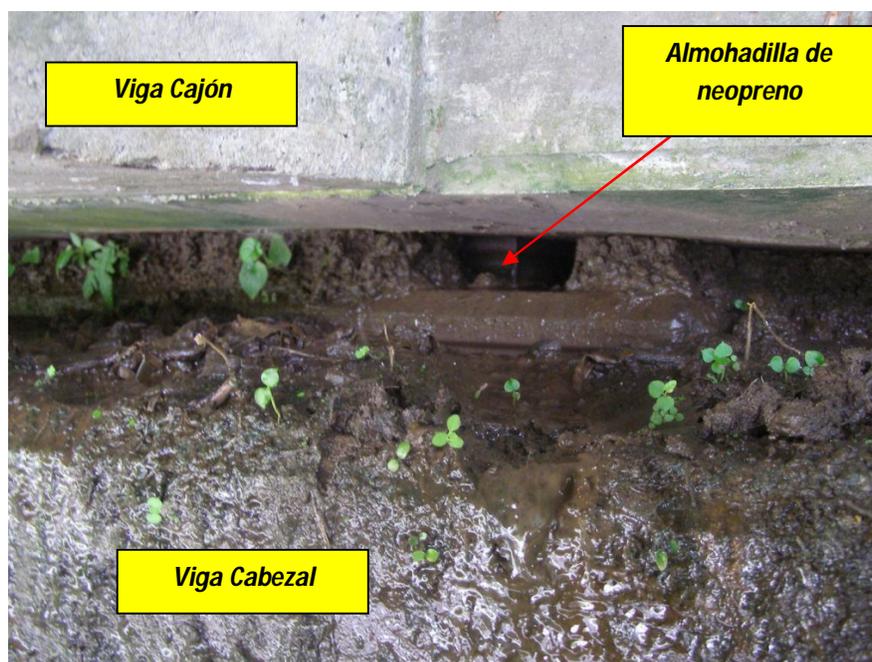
Agua que escurre por el ducto de drenaje de la viga cajón y rastros de eflorescencia en la pila
